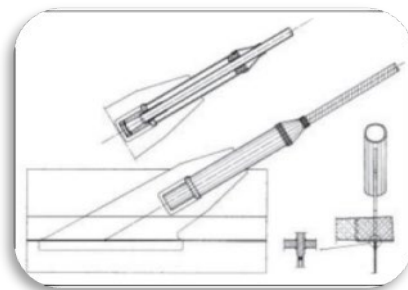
Anclaje con conexión directa al alma de la viga de acero. Fuente: [25]
